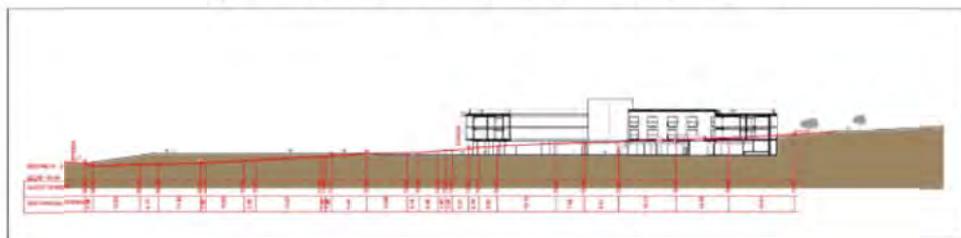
Sezione Struttura alberghiera in progetto
